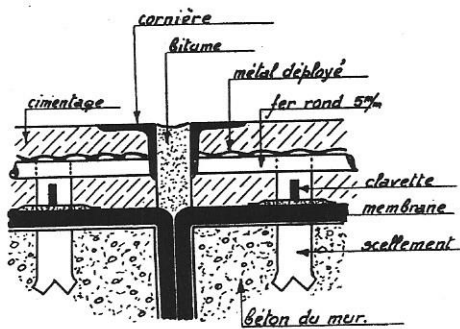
Détail du parement au droit d'un joint de dilatation.
